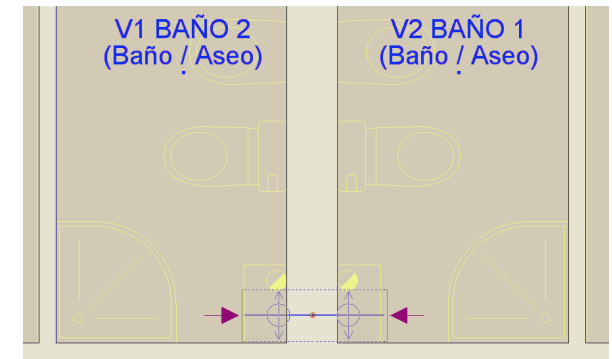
Conexión aberturas de extracción con conductos verticales.
